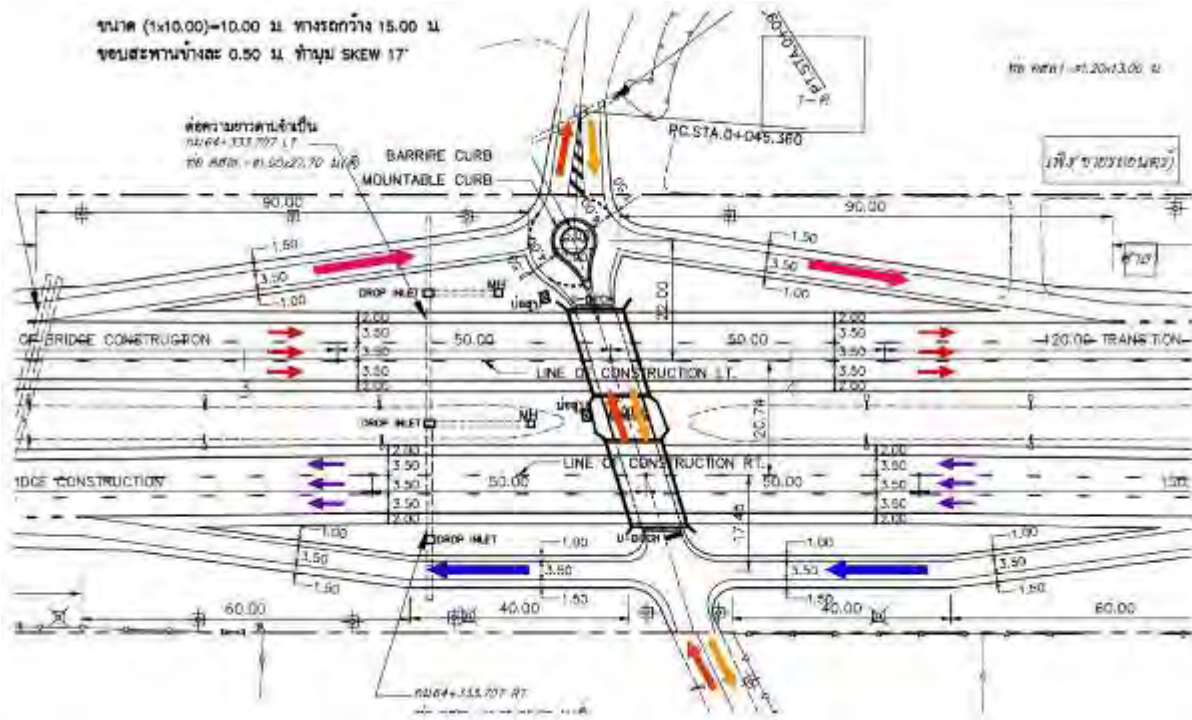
The construction plan and traffic pattern, including drainage, at the Po Koi intersection area
